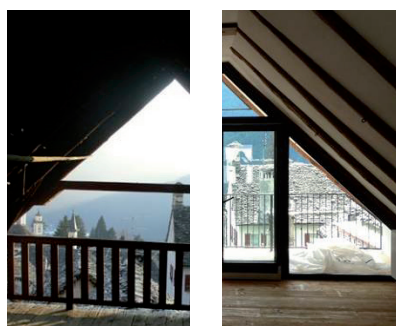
Vista dal sottotetto verso sud, a) prima e b) dopo l'intervento (a seguito della rimozione della trave di rinforzo).
